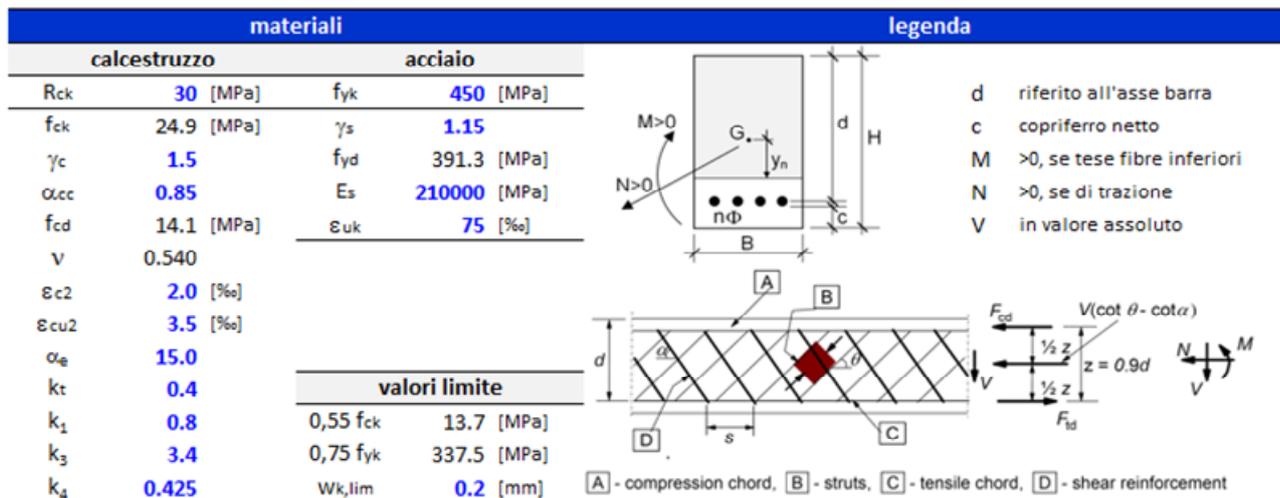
Opera protezione spondale. Verifica flessionale e tagliante muro ca
